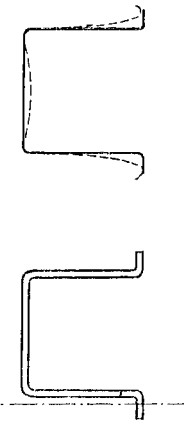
Pierderea stabilității tălpiilor la profile deschise.
